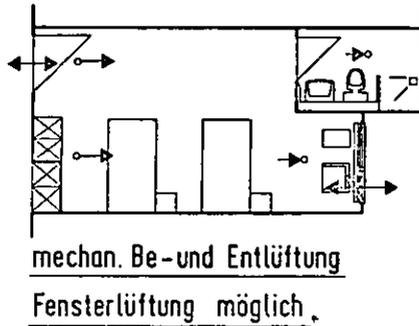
Bettzimmer Krankenhaus Kopenhagen.
